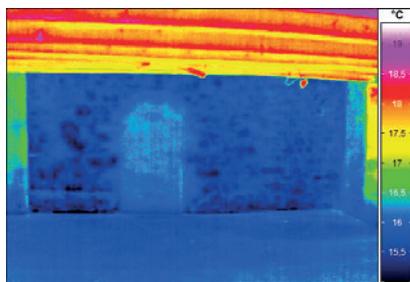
Kaminstrukturen (links), ein alter Durchgang (Mitte) und vermutlich ein querliegender Holzbalken mit einem darunterliegenden eh. Durchgang (rechts) im 2. Obergeschoß.
